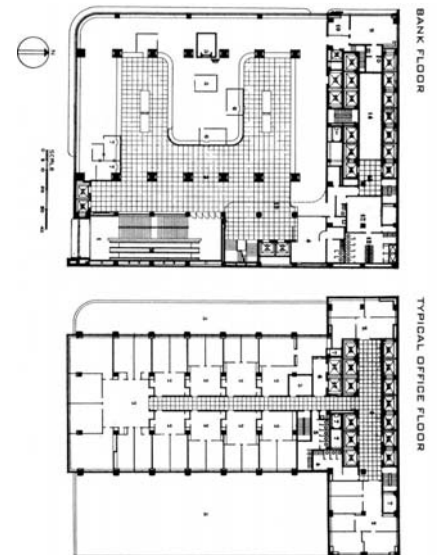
PSFS Building, Filadélfia, Pensilvânia, 1929-1932., plantas.
